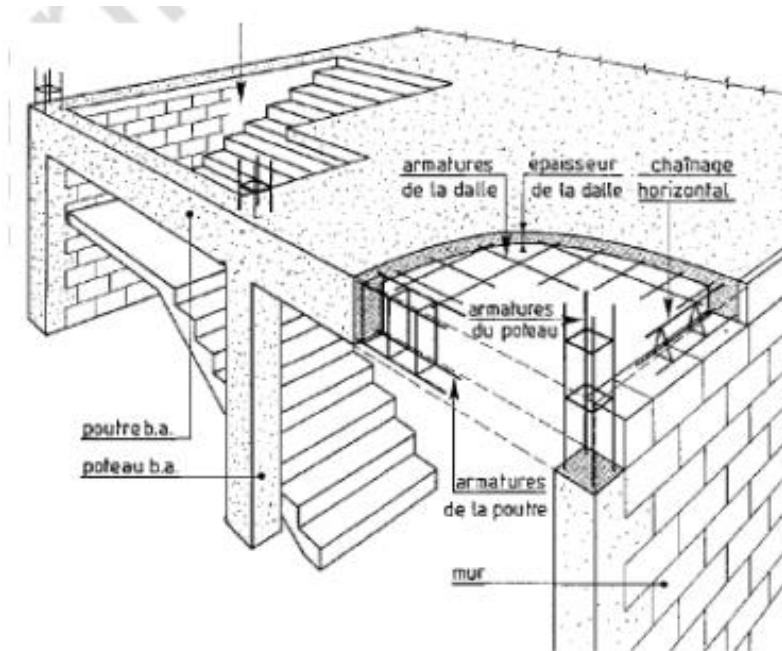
Les Éléments Principaux D'un Plancher A Dalle Pleine
